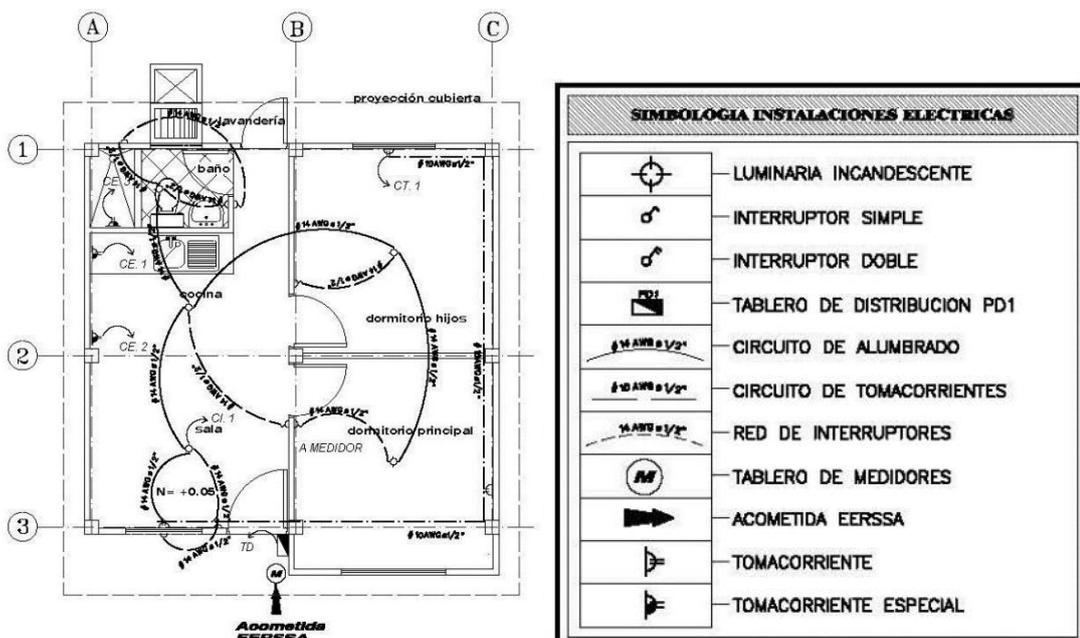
Plano Eléctrico vivienda tipo (MIDUVI).
